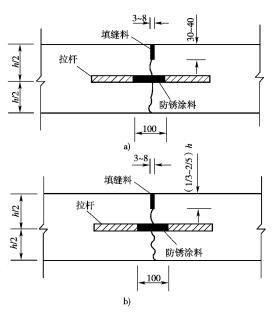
纵缝构造(尺寸单位 imm) a)纵向施工缝 b)纵向缩缝
